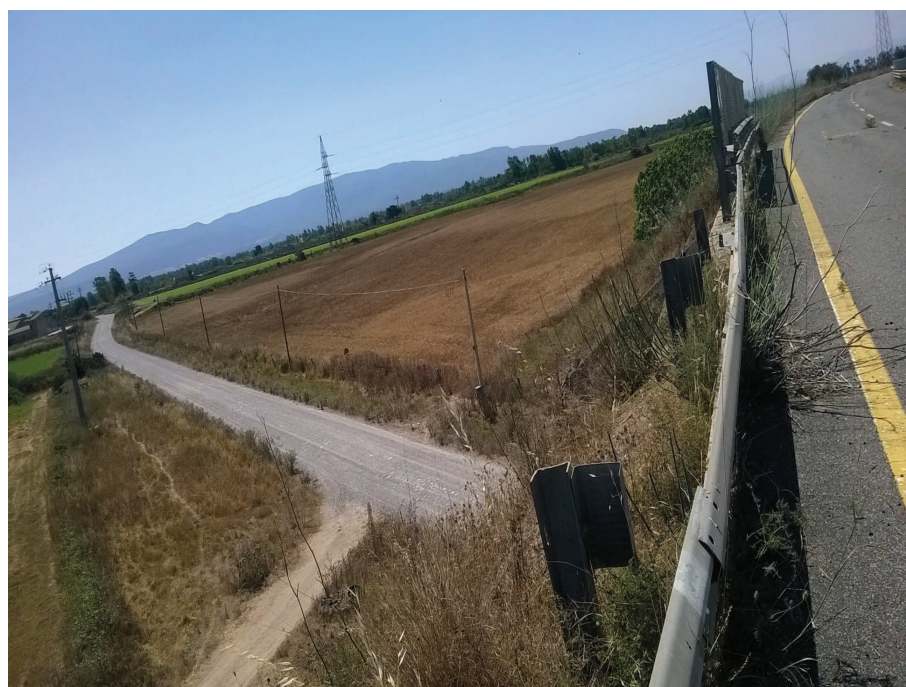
Reliquato ex SS 131 pressi sottopasso (smontaggio barriera bordo laterale, smontaggio rete parasassi e paletti, cancellazione segnaletica, smontaggio/montaggio barriera centrale, sfalcio erba, smontaggio frangiluce, riparazione buche pavimentazione)
